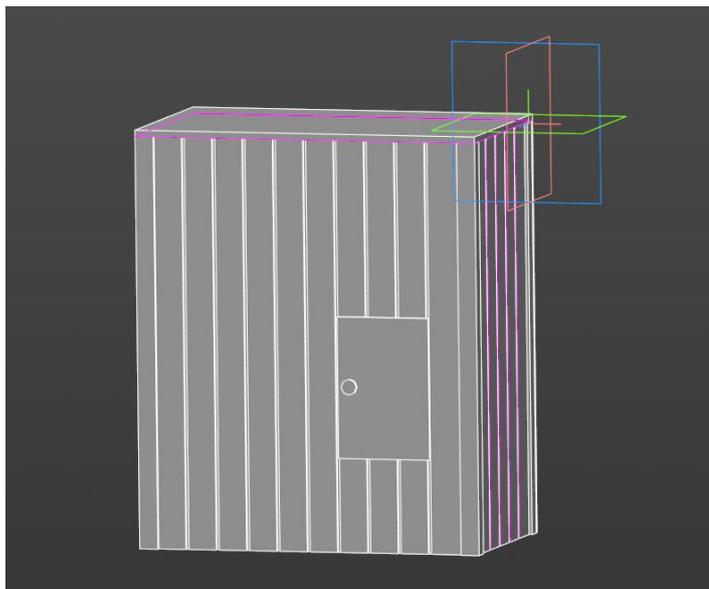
Эскиз бытовки для метанола и откачки конденсата
